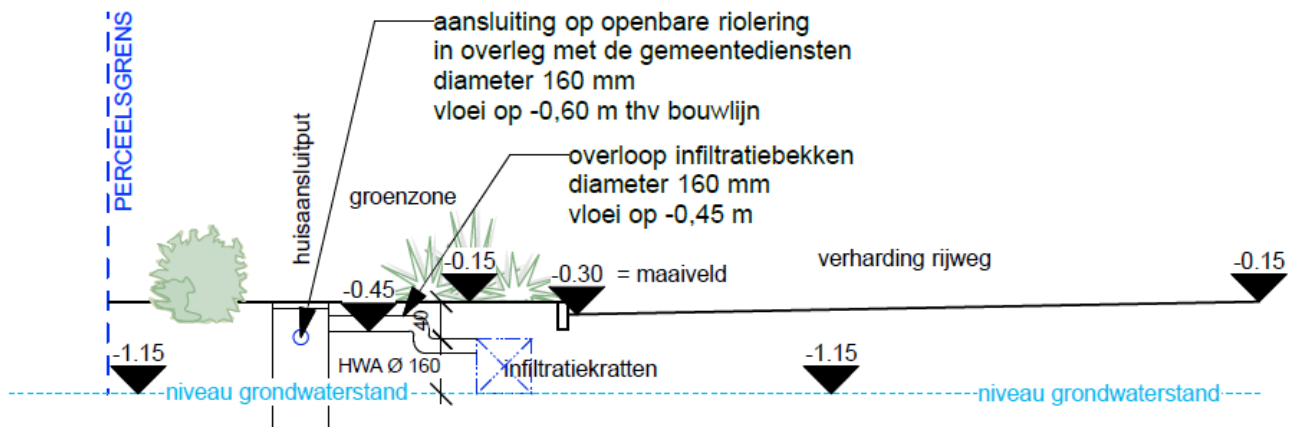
Inplantingsplan (zie ook bijlage 1, bron: opdrachtgever).
